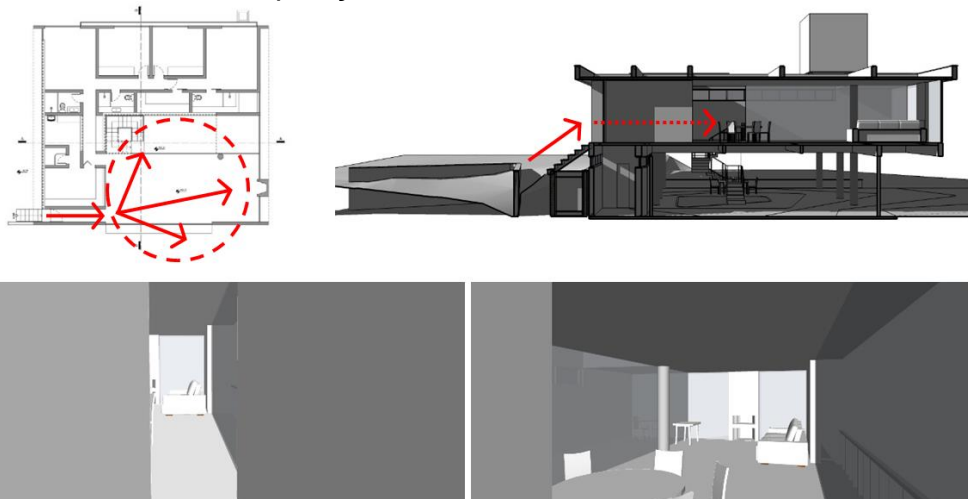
Planta Baixa do segundo pavimento e Corte Perspectivado com esquemas de tensões multidirecionais sobre vistas internas no Modelo tridimensional
